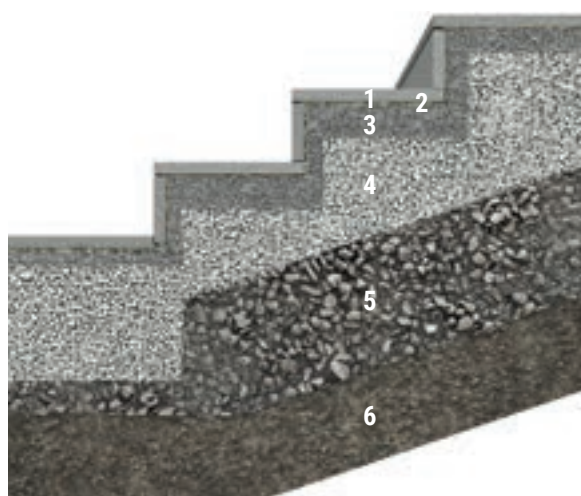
Stufenaufbau mit Blocksteinen im Drainbetonbett
